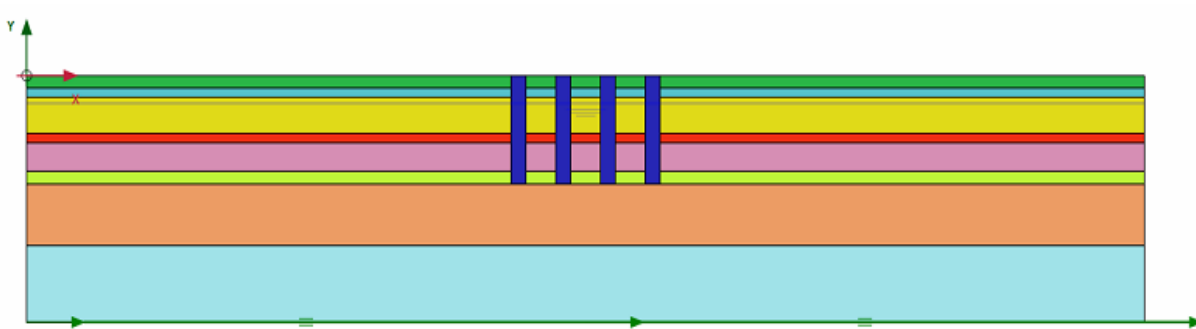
Modelación de Mejora B4 con Soil Mixing, 4 Columnas. (Fuente: Captura Plaxis 2D).
